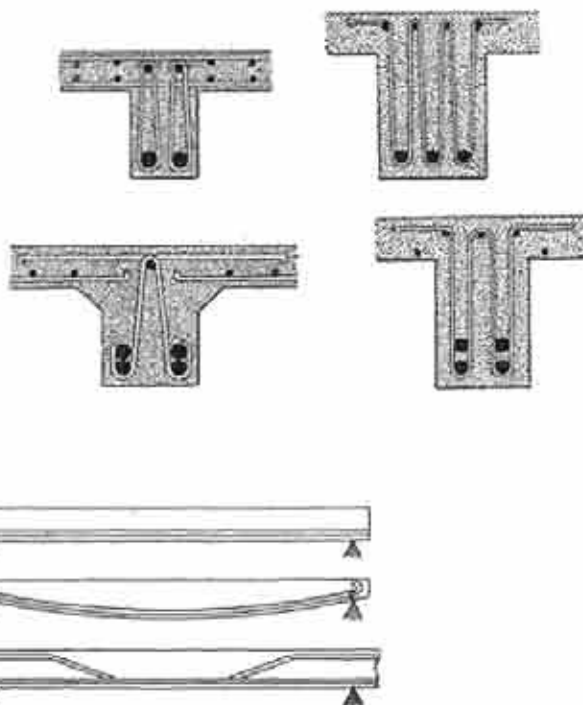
Construcción monolítica de hormigón armado, sistema *Hennebique*.
